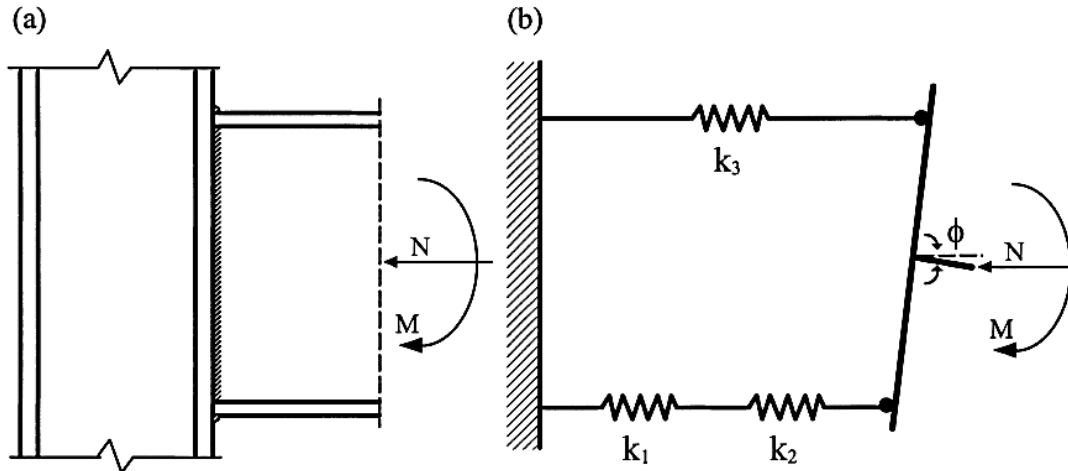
Modèle de calcul mécanique d'un Assemblage poutre-poteau soudé [51].
